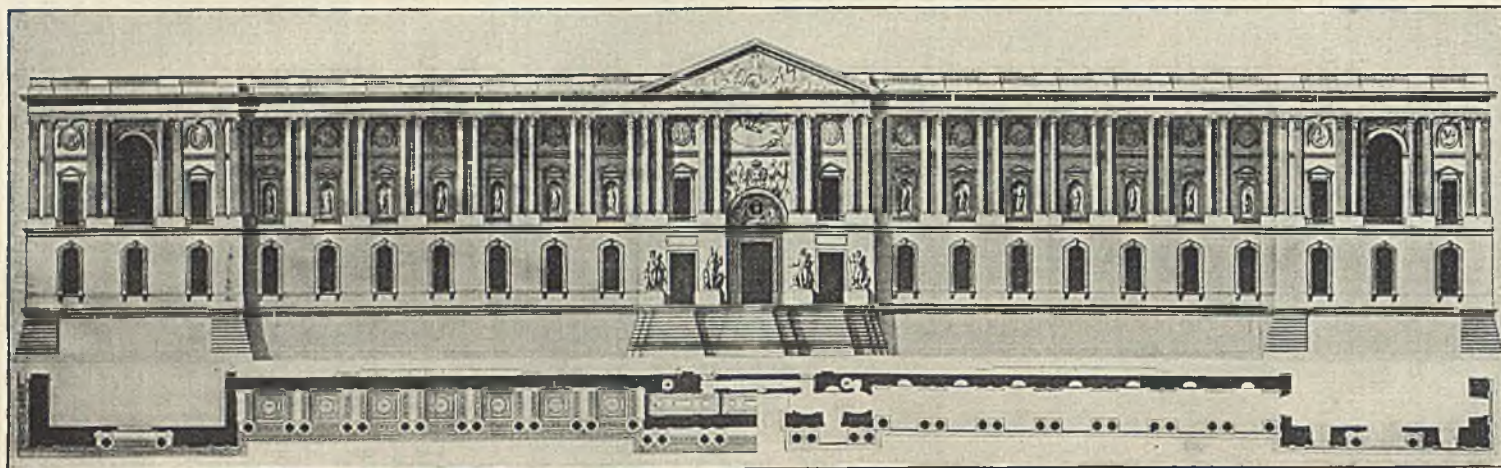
Perraults Plan für die Louvrefassade (Nach einem Stich von F. Blondel)
